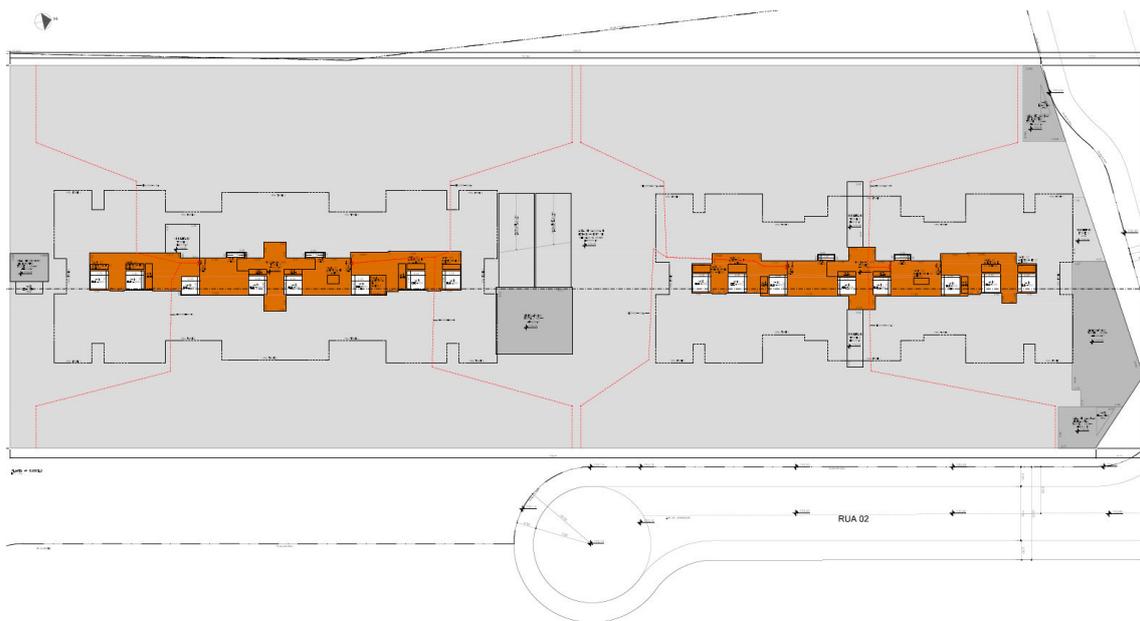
Planta do 4º Subsolo das Torres 1 e 2 do setor B1.
